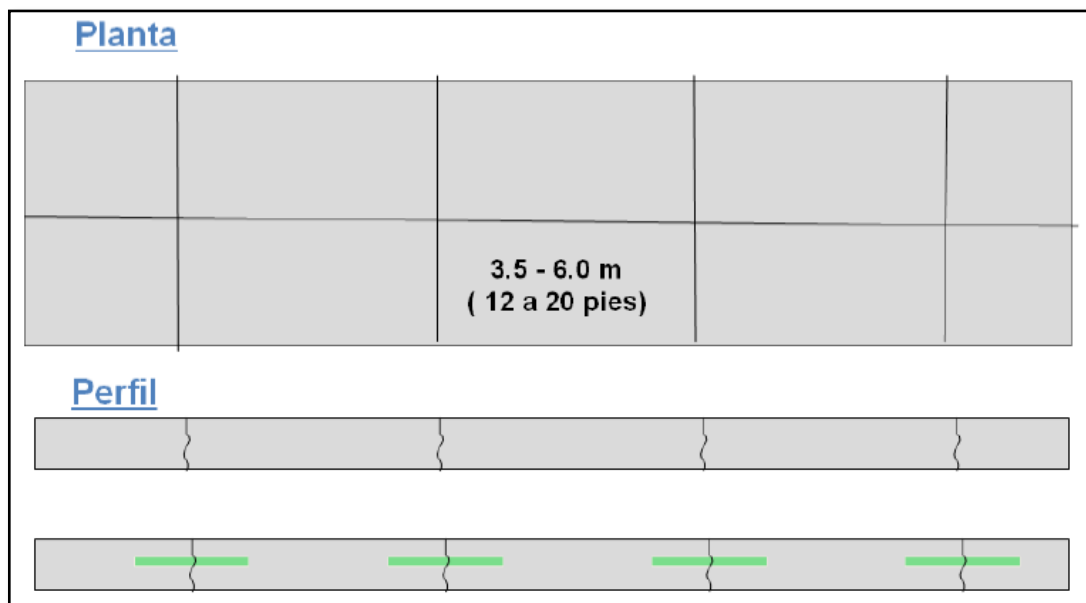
Esquema de pavimento de concreto simple con juntas. (Becerra, 2012)
